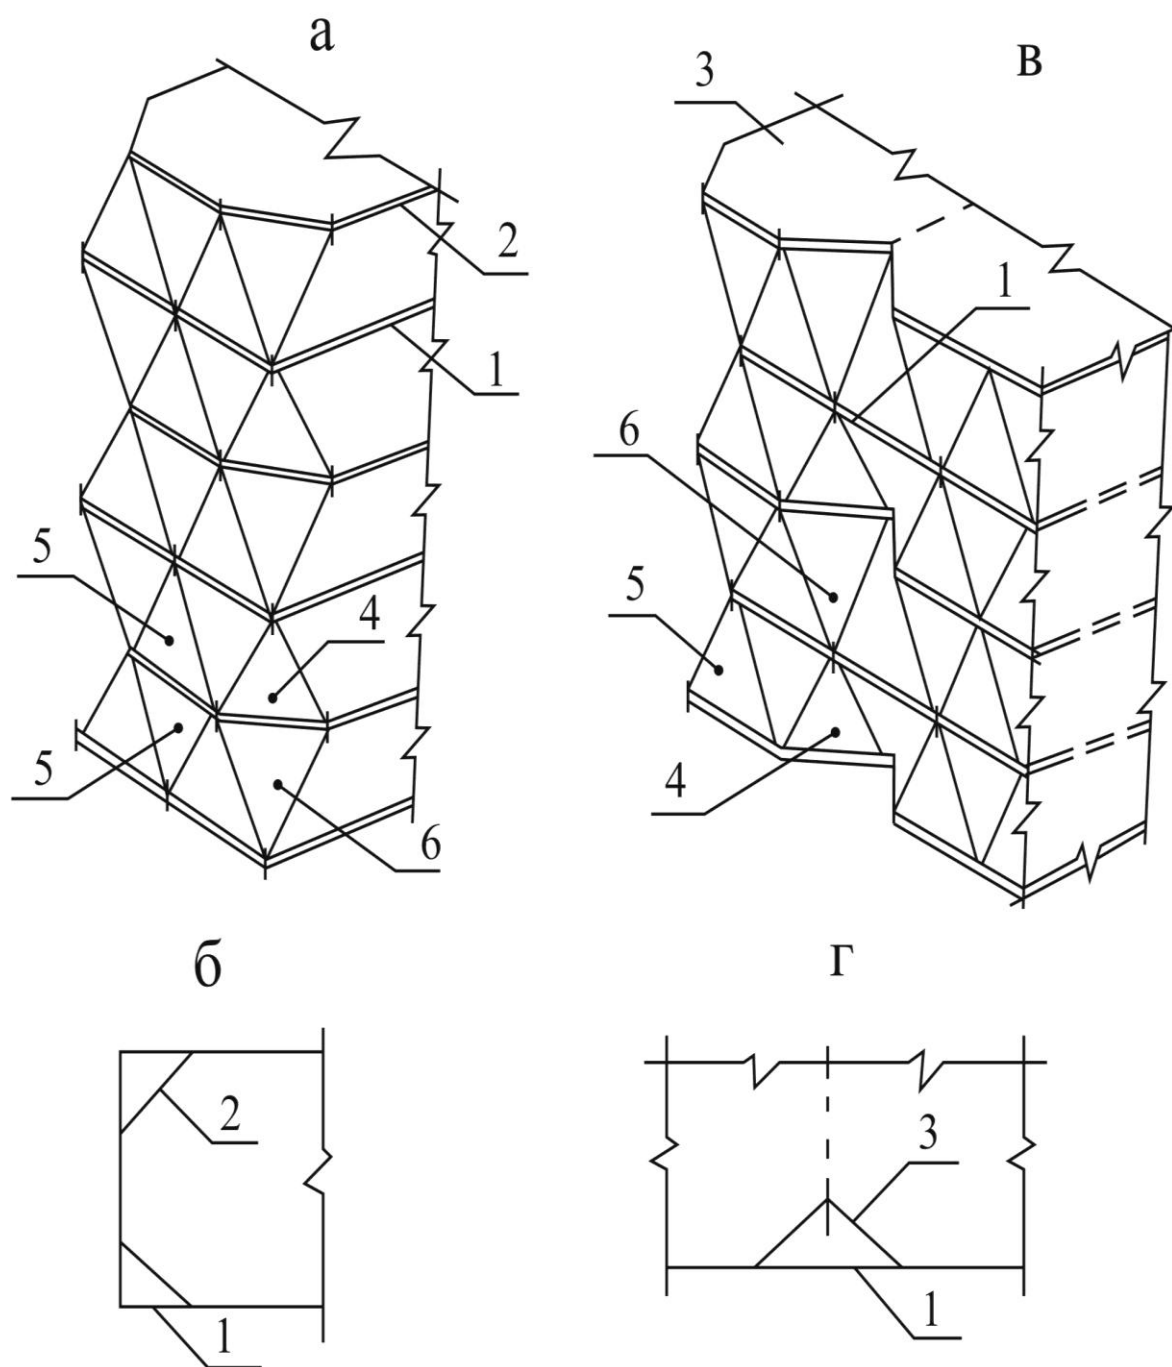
Схемы фасадов многоэтажных зданий с периферийной несущей системой: 1, 2, 3 – перекрытия; 4, 5, 6 – треугольные элементы несущей периферийной системы
